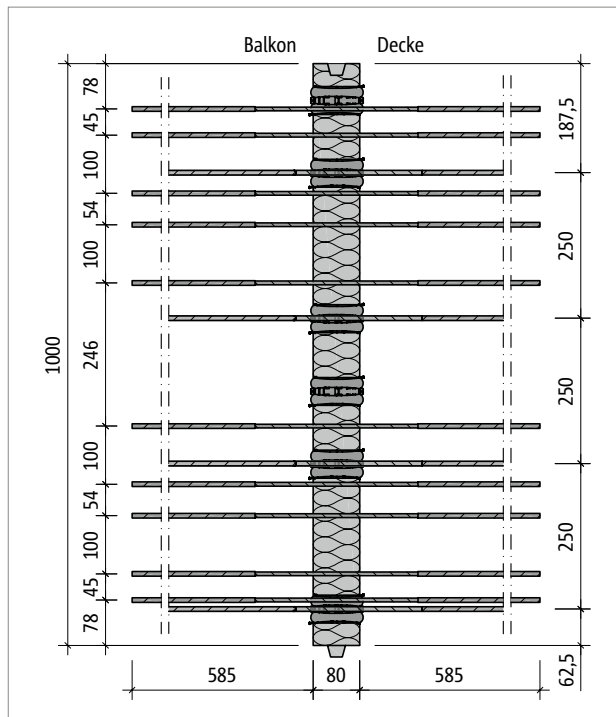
Schöck Isokorb® T Typ KL-M4-V1: Produktgrundriss
